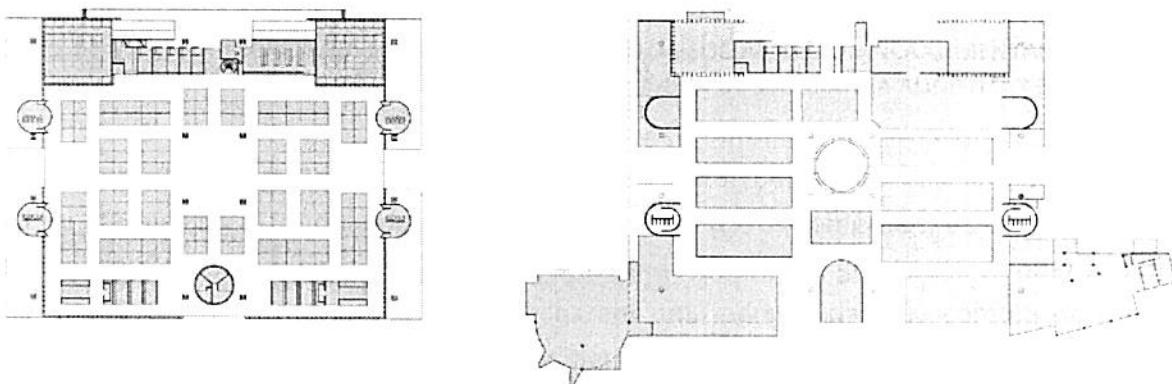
Planta Original (projeto Éolo Maia) X Planta Atual (levantamento)
